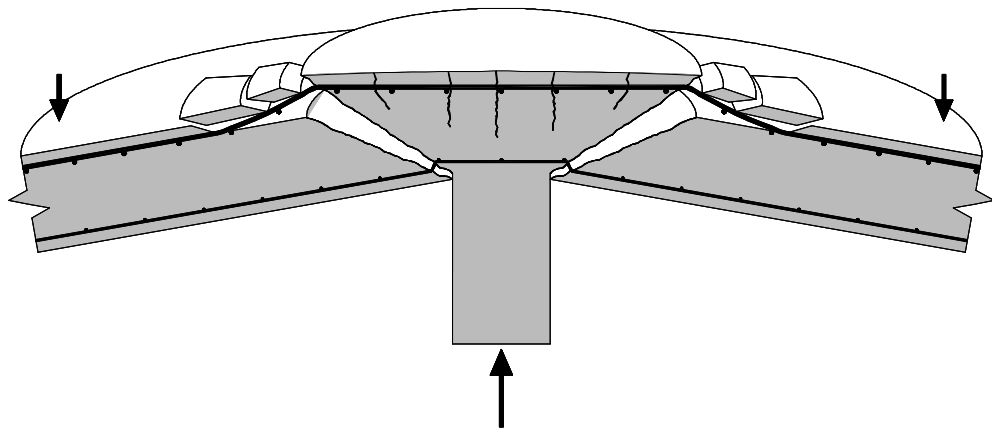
Rupture par poinçonnement d'une dalle en béton armé
